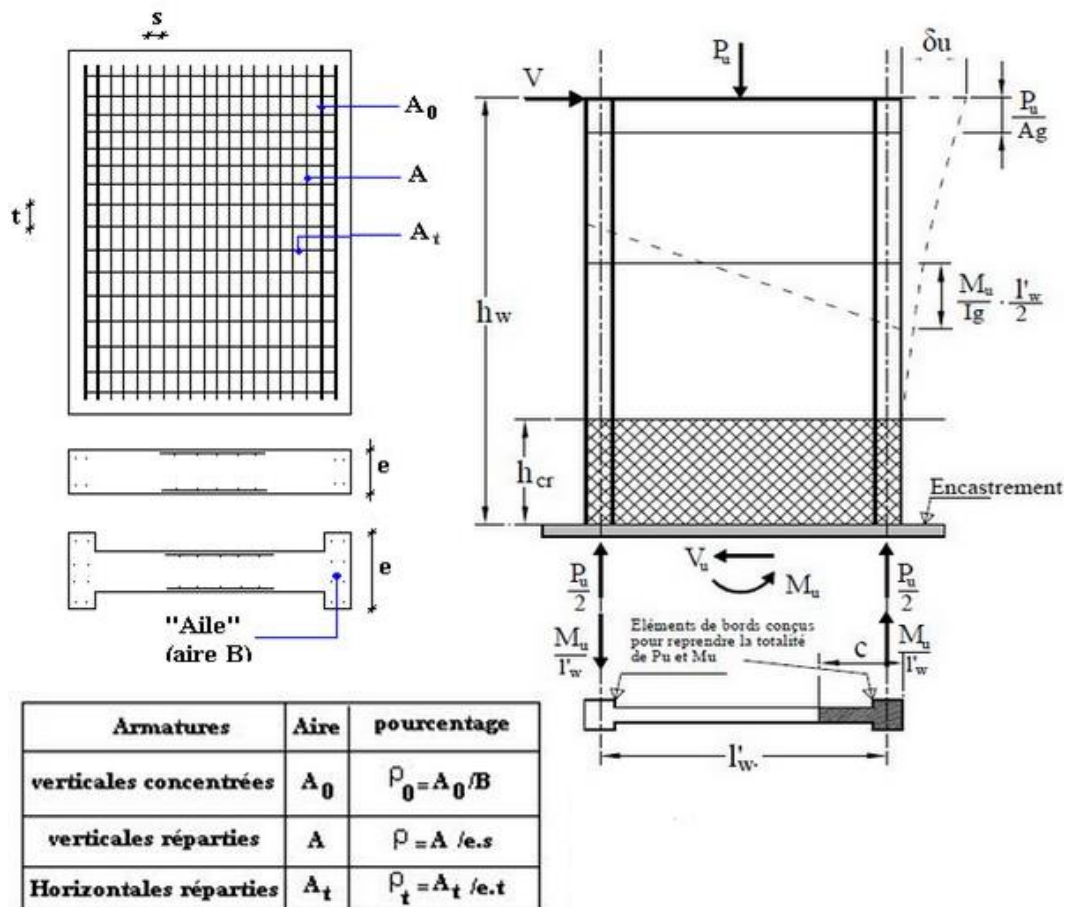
Schéma d'un voile plein et sa disposition de ferrailage.
